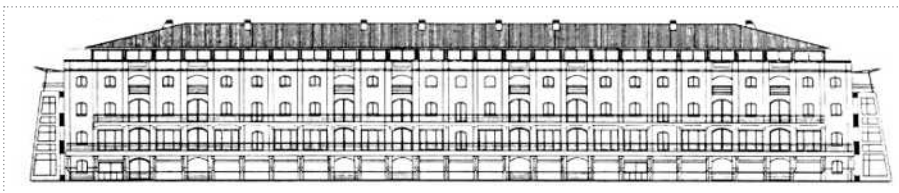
Fachada leste Galpão 5. Fonte: Revista Arquis nº 1.
